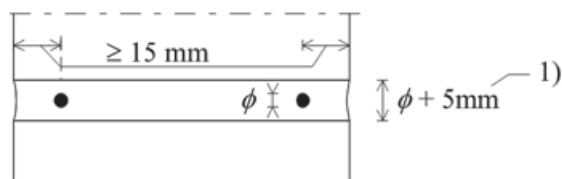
NEN-EN 845-3 trusstype lintvoegwapening.
